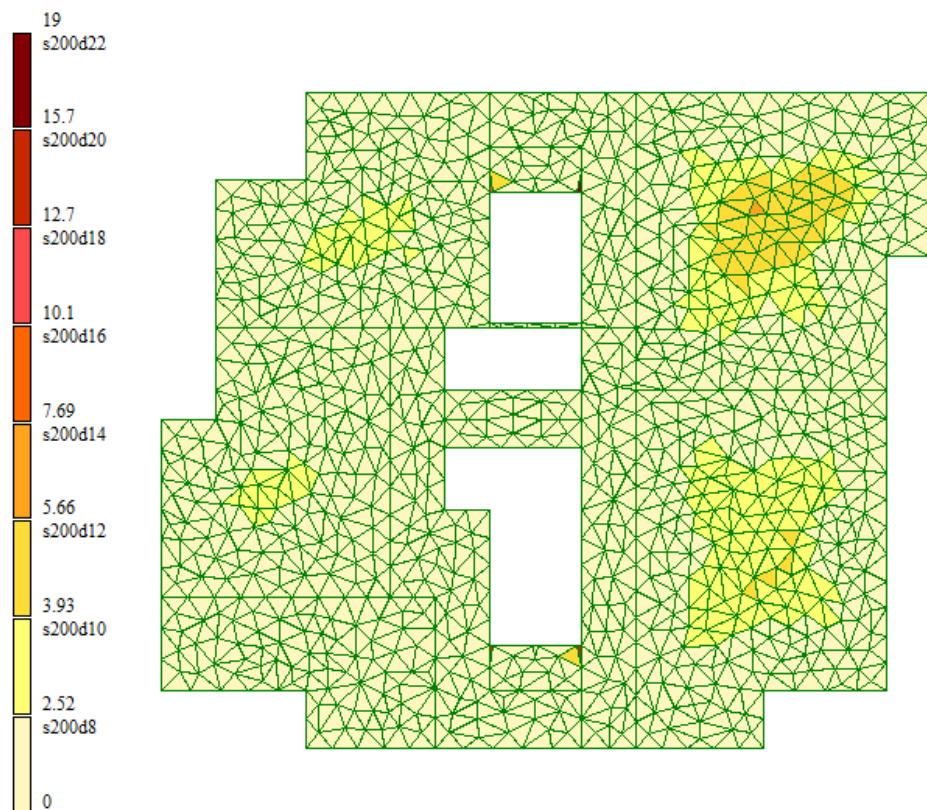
Схема армирования плит перекрытий по оси Y (у нижней грани)
